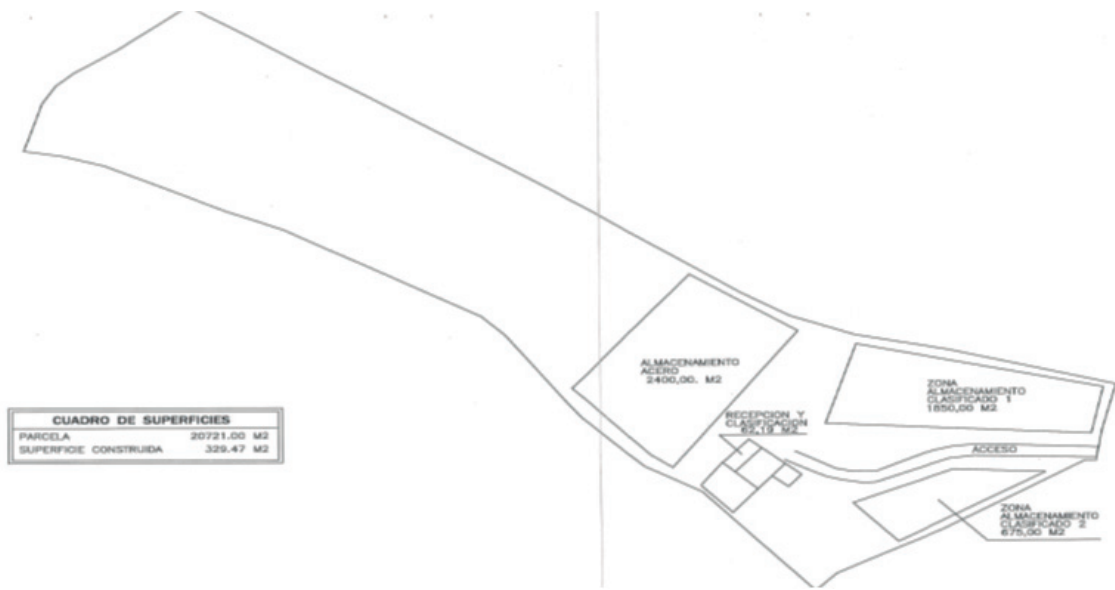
Plano en planta de la parcela con las zonificaciones y edificaciones
